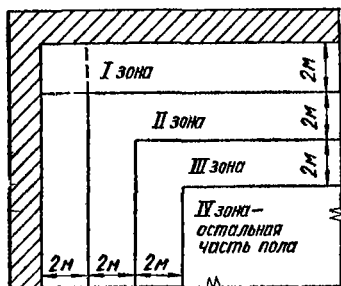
Разбивка площади неутепленных полов, лежащих на грунте, на условные зоны.
